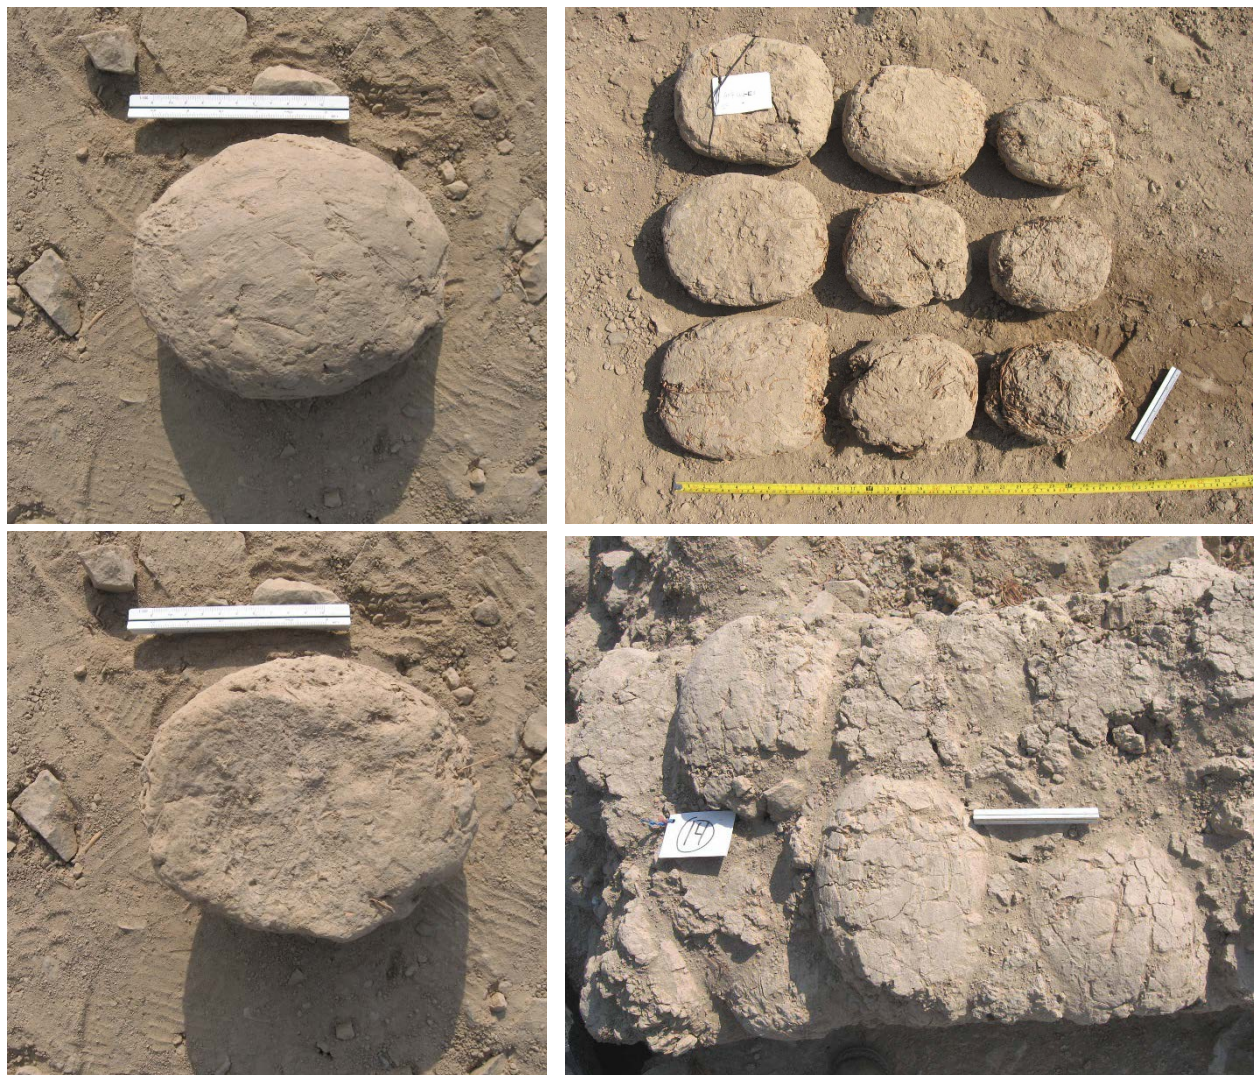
Detalle de la unidad constructiva “adobe plano-convexo”. Edificio norte, Shicras.
